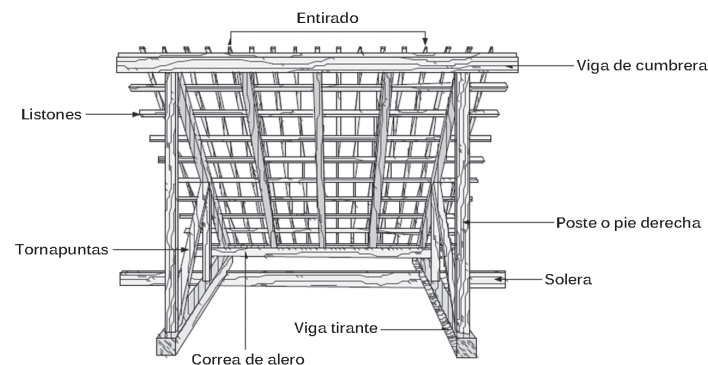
Detalle del armado de las correas en la estructura de cubierta.
